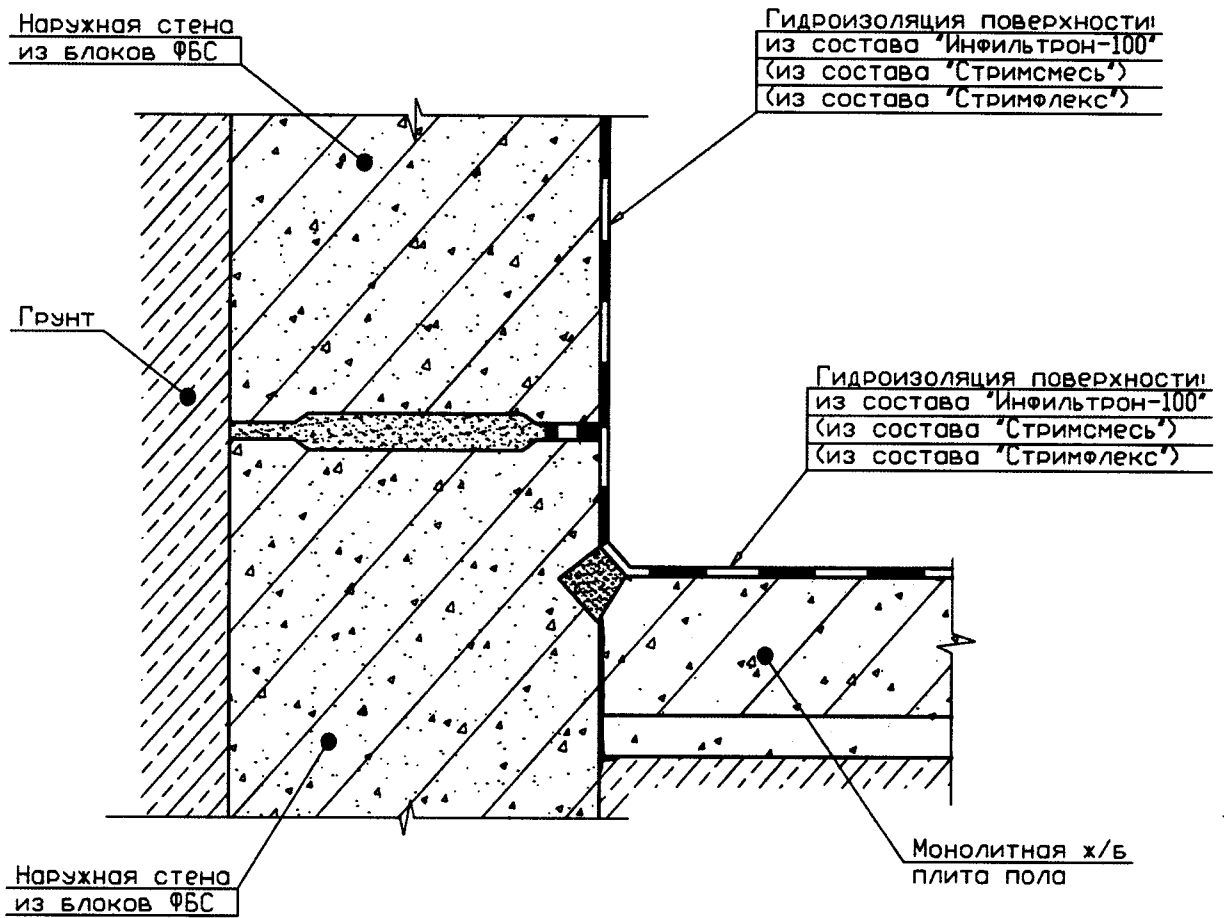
Гидроизоляция поверхностей сборных железобетонных конструкций. Гидроизоляция поверхностей наружных стен из блоков ФБС и плиты пола
